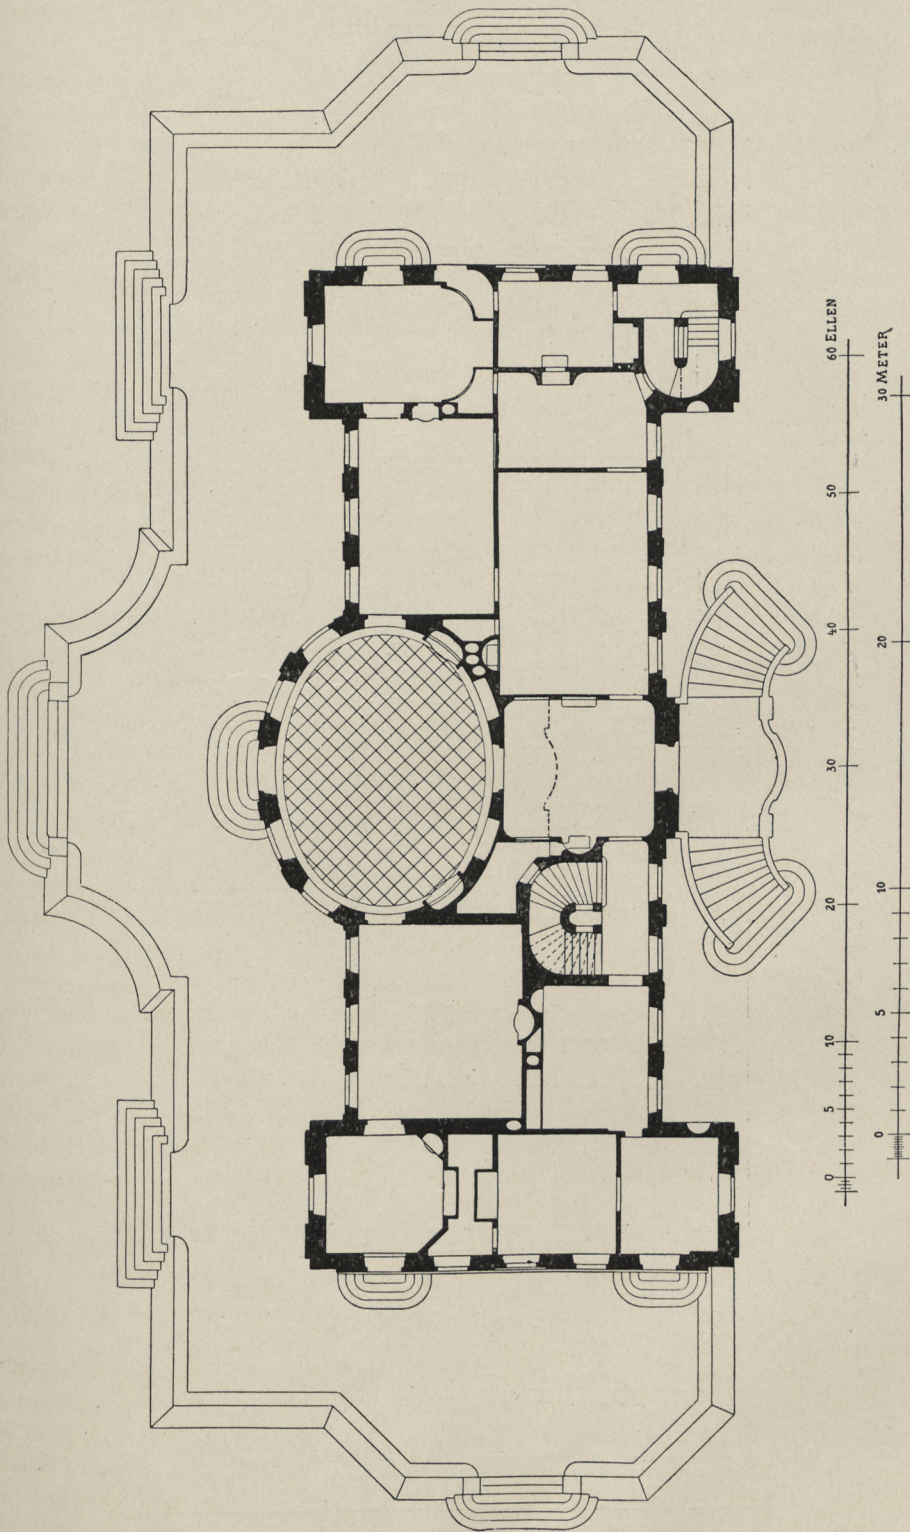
Mosczinska - Palais, Grundriss des Erdgeschosses.
